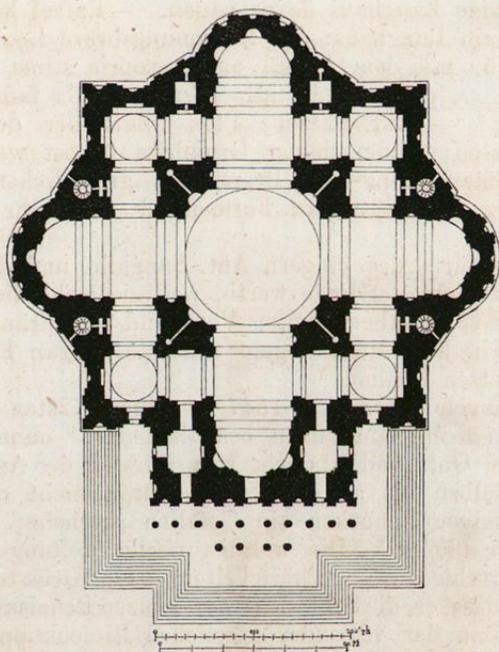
S. Peter. Michelangelo's Grundriss.
